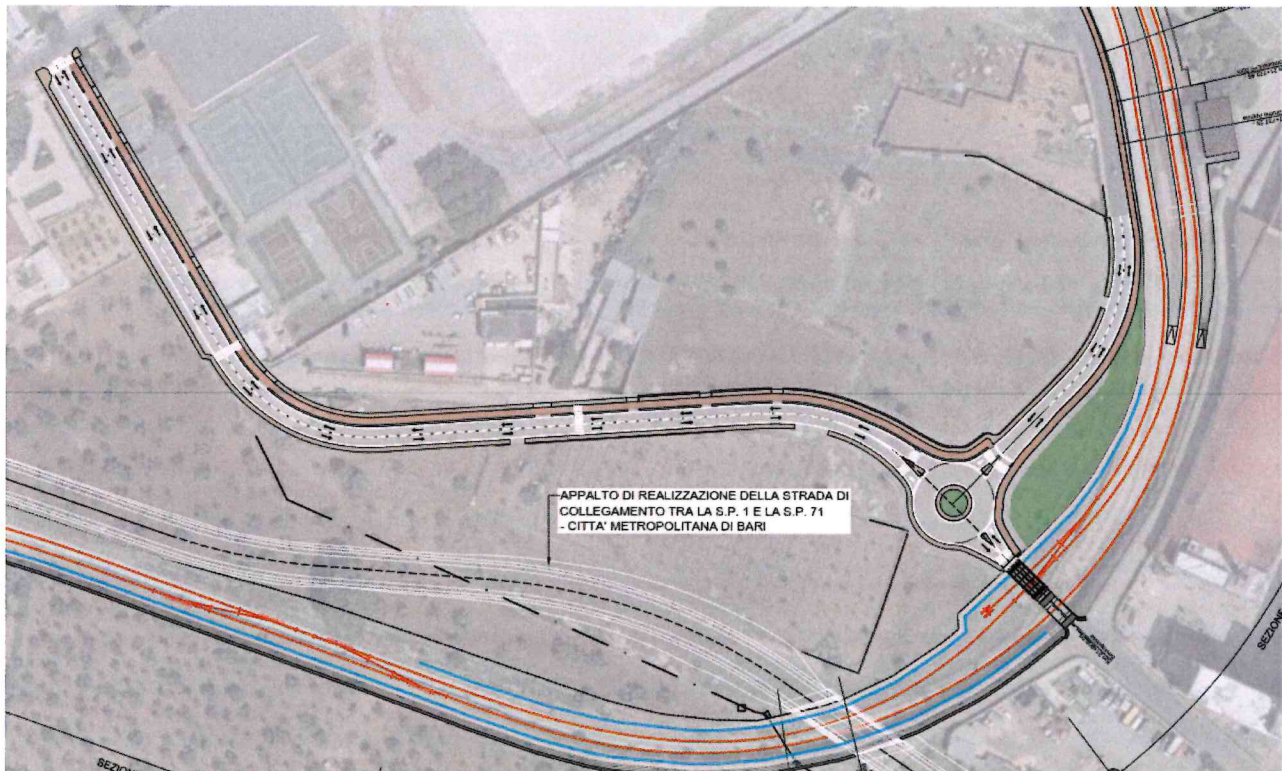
Strada di collegamento Via Roma – Via E.Bonavoglia- Planimetria su base ortofoto
